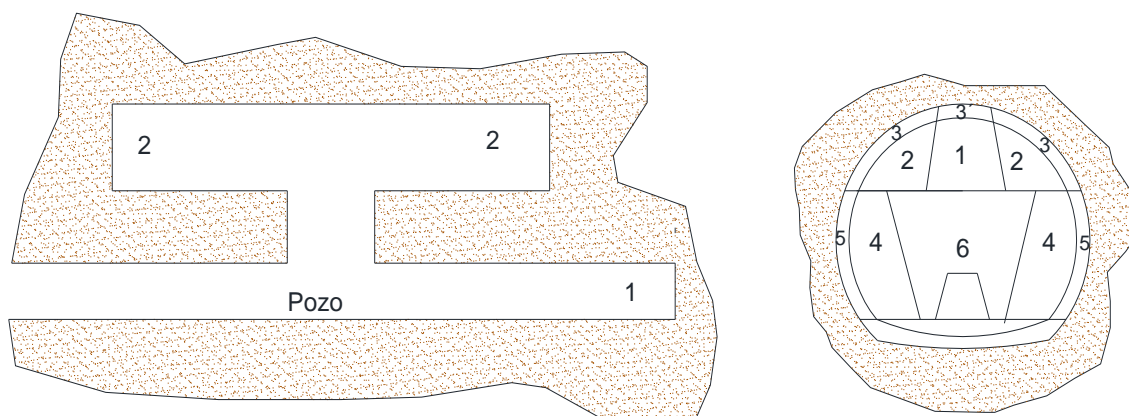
Secuencia de excavación de las dos Galerías [4].
